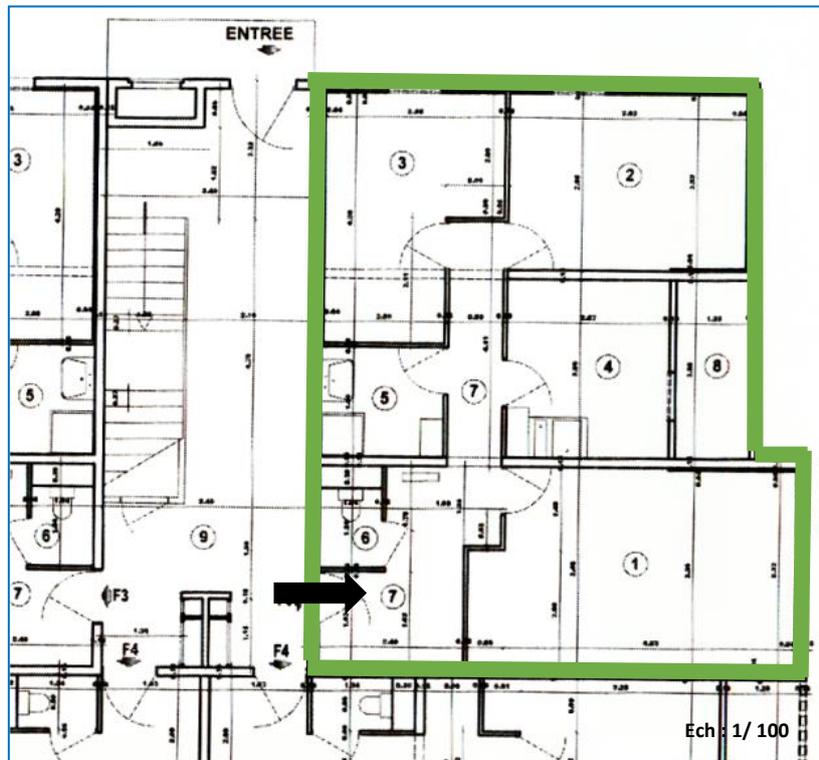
Disposition spatiale en plan du logement 03 en bloc 07. Source : Auteur, 2022
